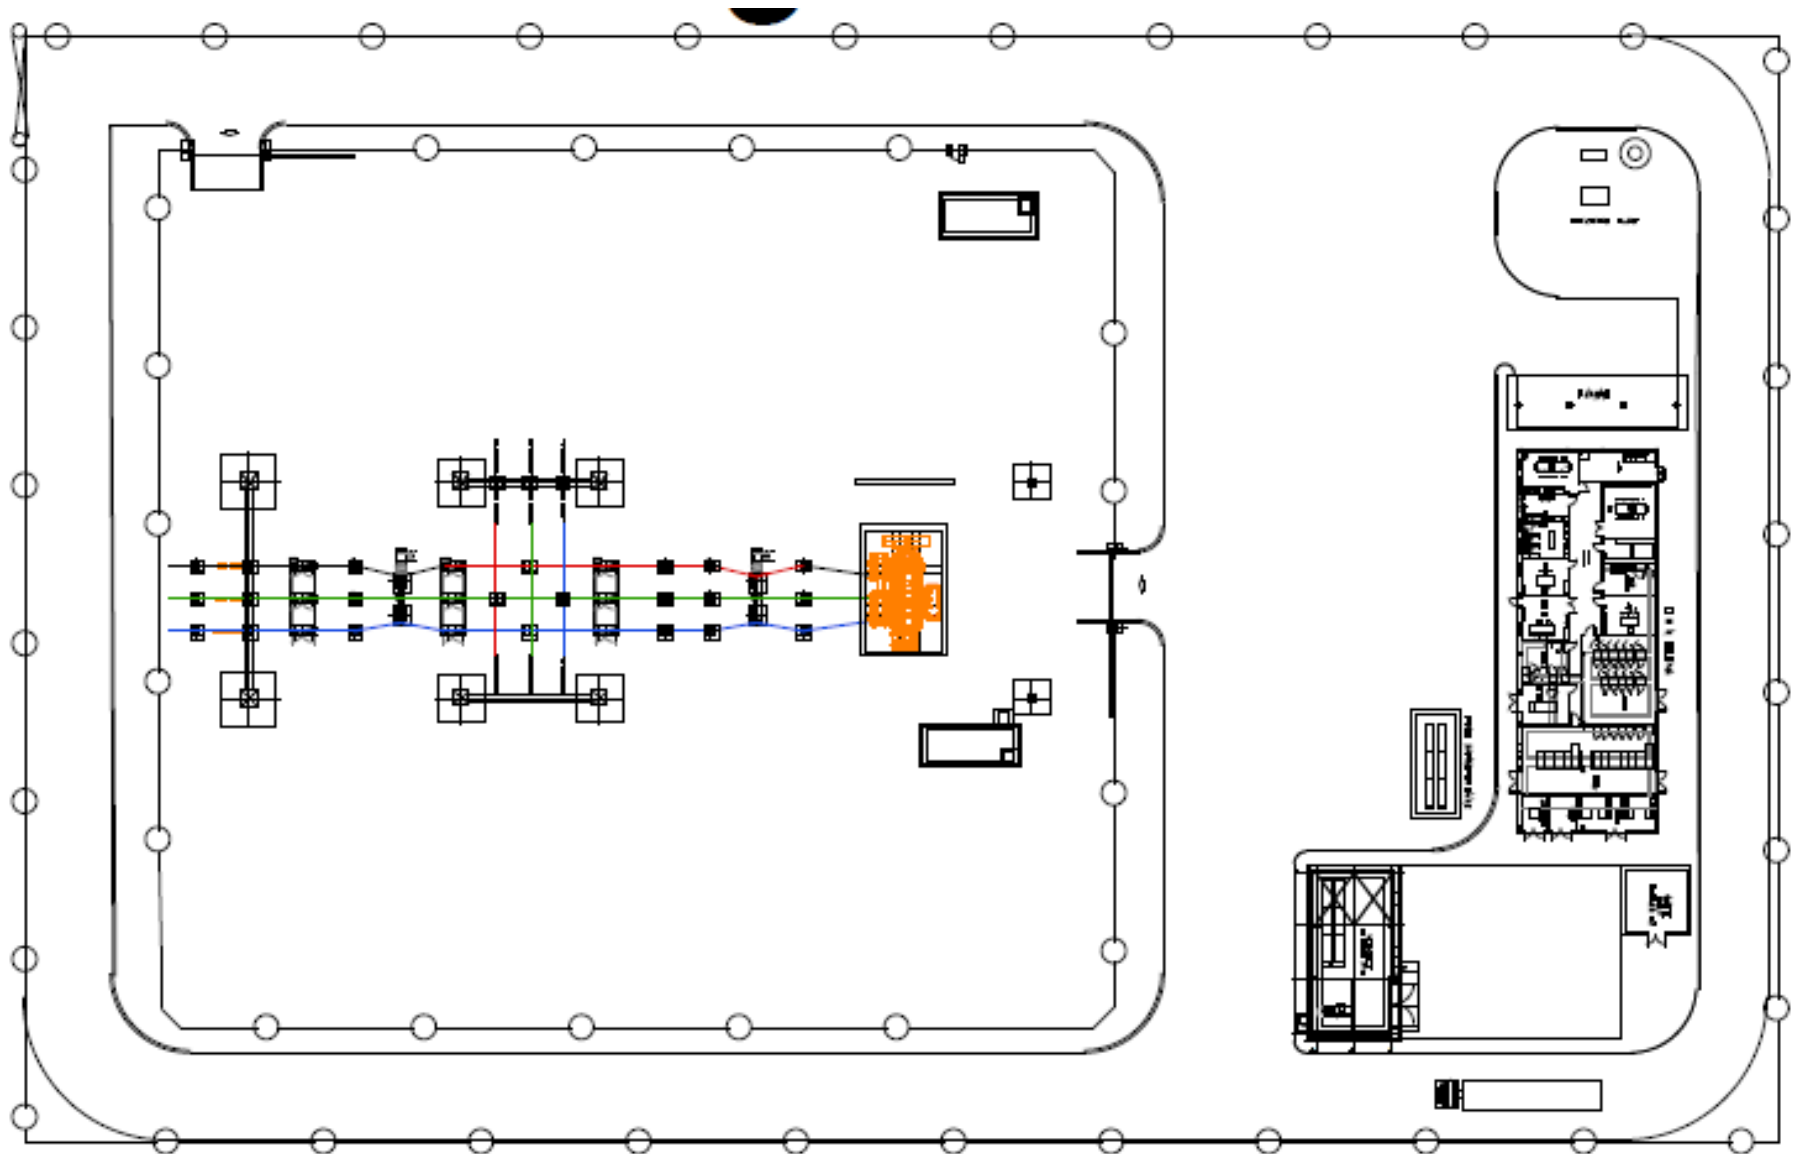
Layout preliminar de la subestación transformadora y las instalaciones de control de la planta fotovoltaica.
